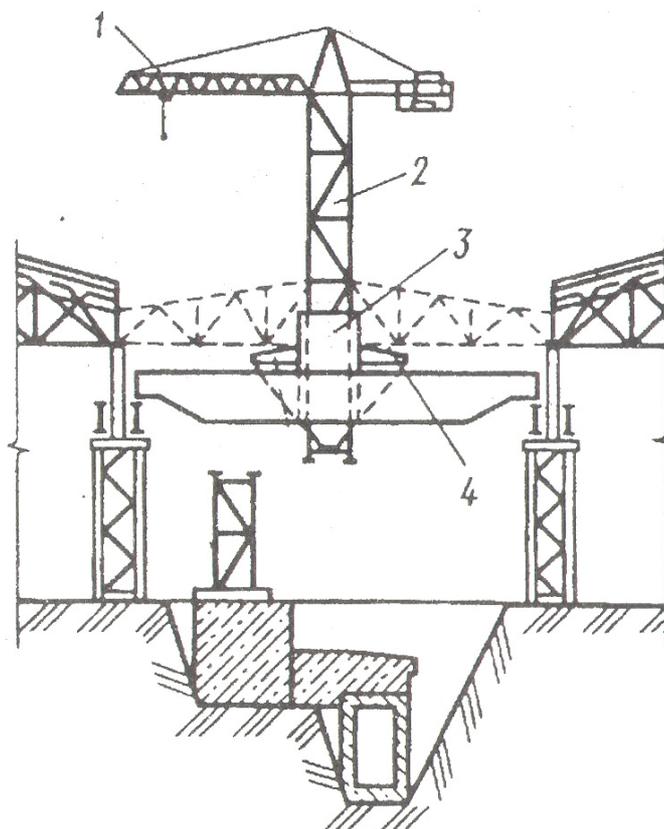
Вариант использования мостового крана для монтажно-демонтажных работ: 1 — мостовой кран; 2 — башенный кран; 3 — обойма; 4 — подрачиваемая секция крана
